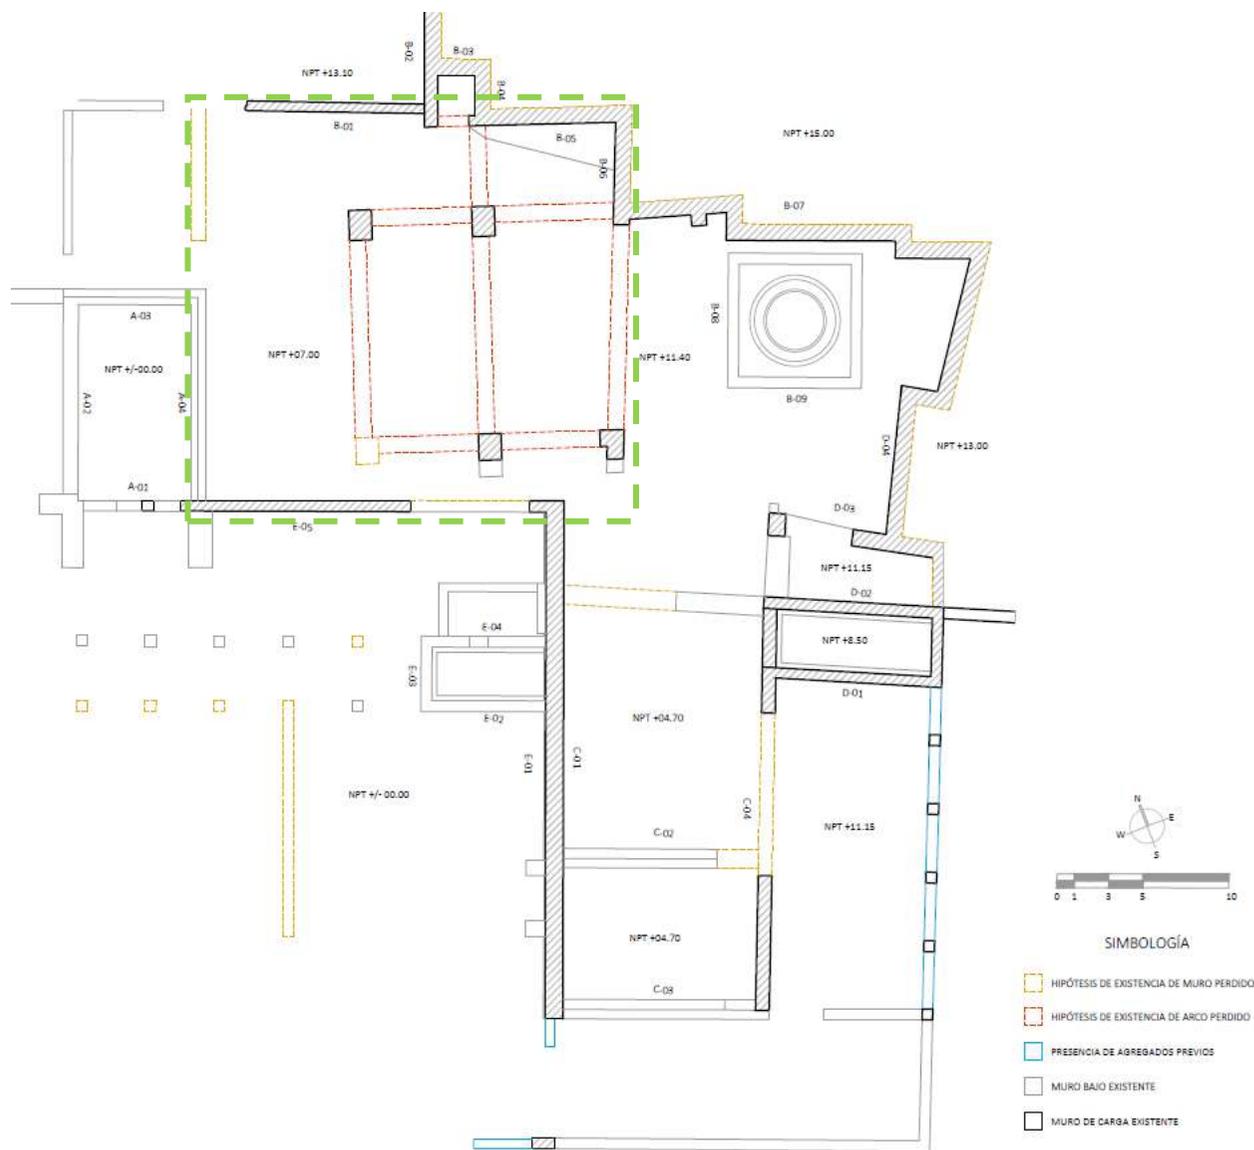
Planta de la zona de estudio. El área seleccionada corresponde al taller de fundición.
